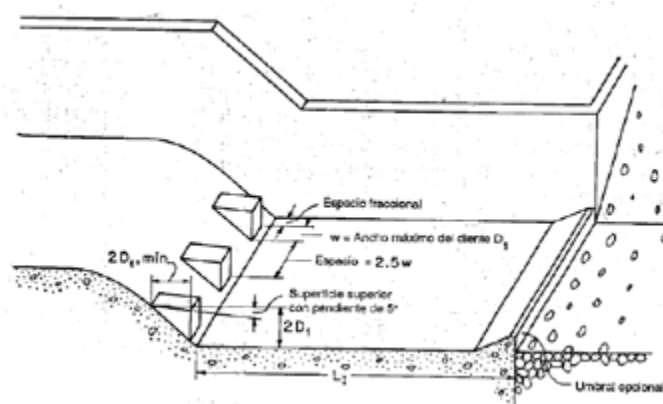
Dimensiones del cuenco disipador USBR IV.
